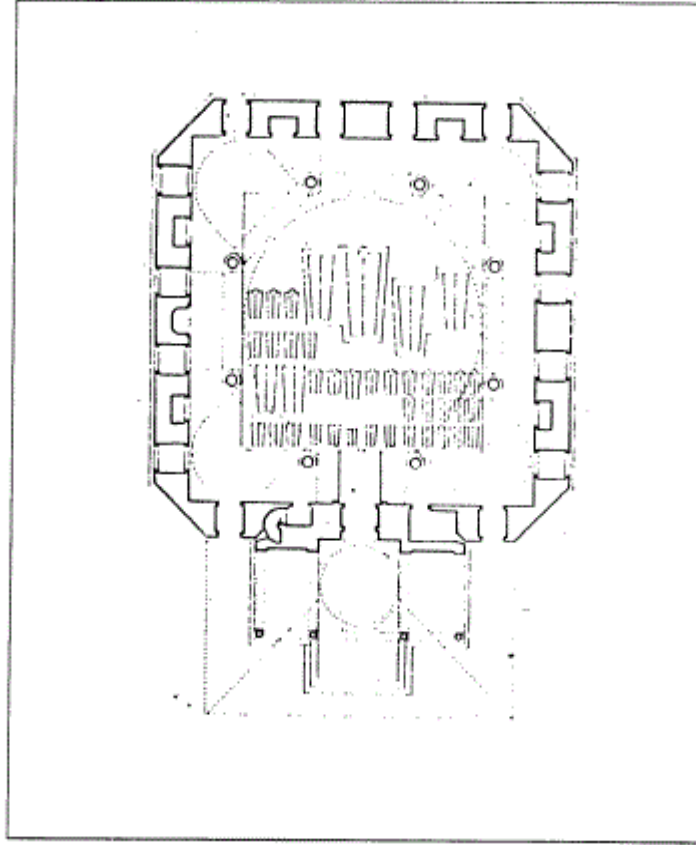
مسقط أفقي لمكتبة راغب باشا في إستانبول (عن : جودوين) .
